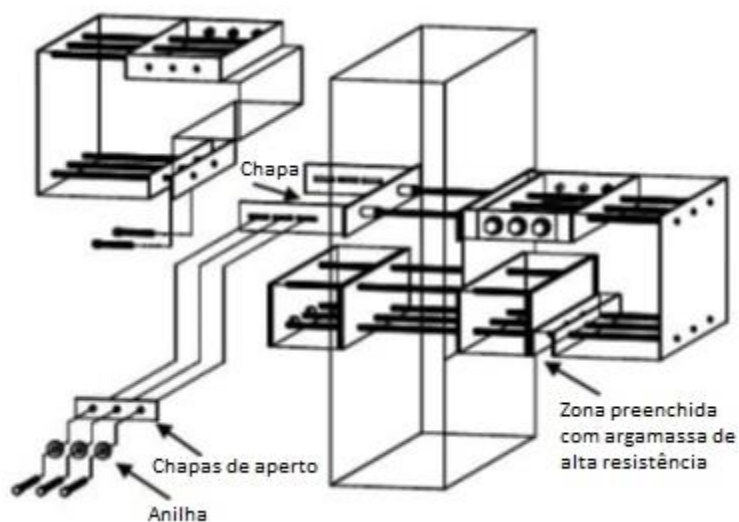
Ligação Viga – Pilar com recurso a ligação aparafusada
